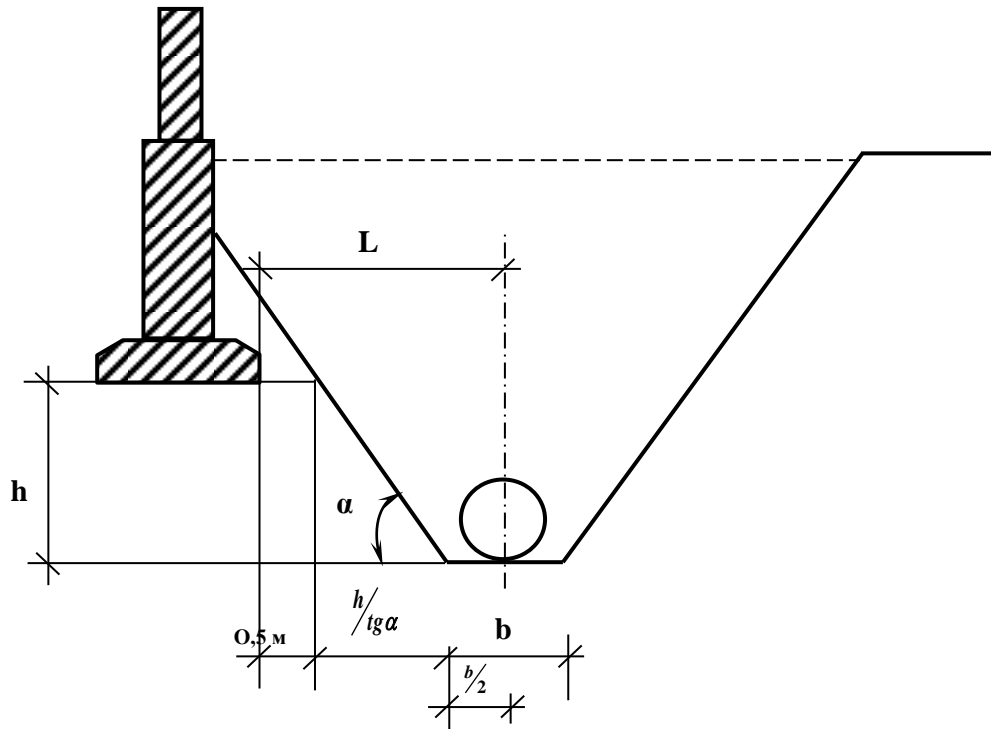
Схема визначення відстані між фундаментом будівлі та водовідвідним трубопроводом
